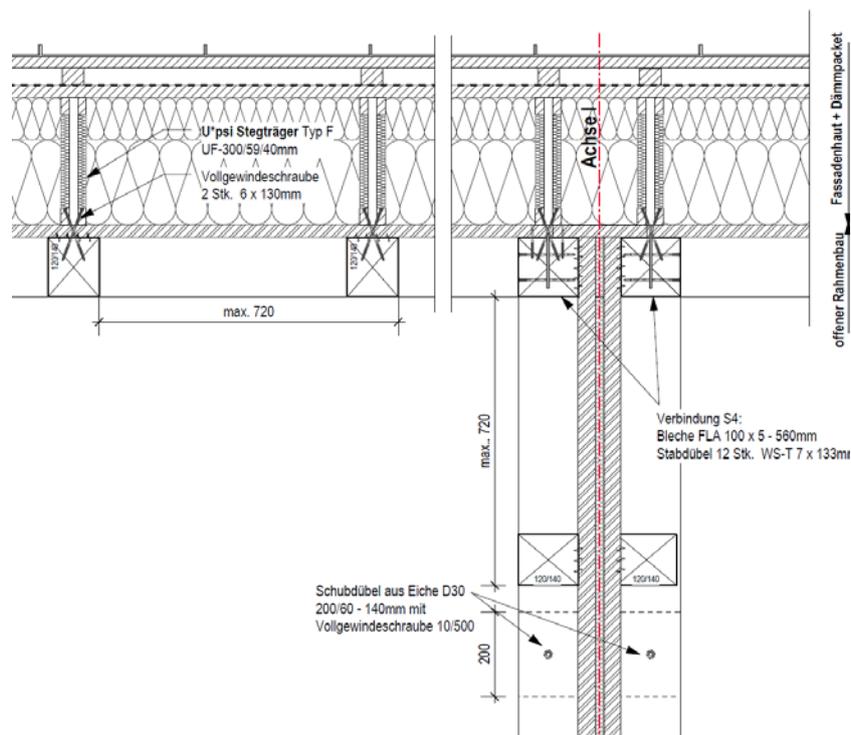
Innen- und Aussenwand im 1.Obergeschoss
